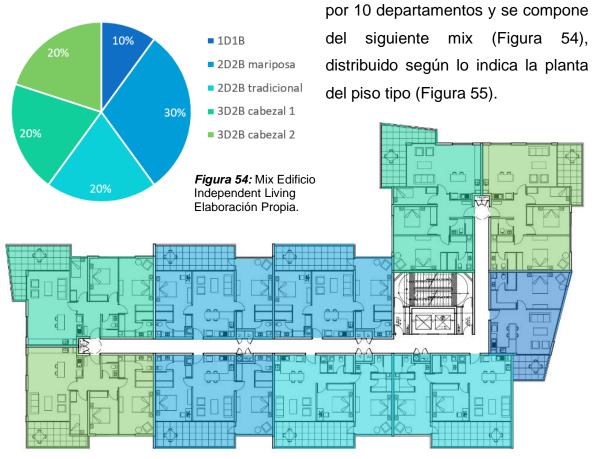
Tipologías en Planta Piso Tipo Elaboración Propia.
